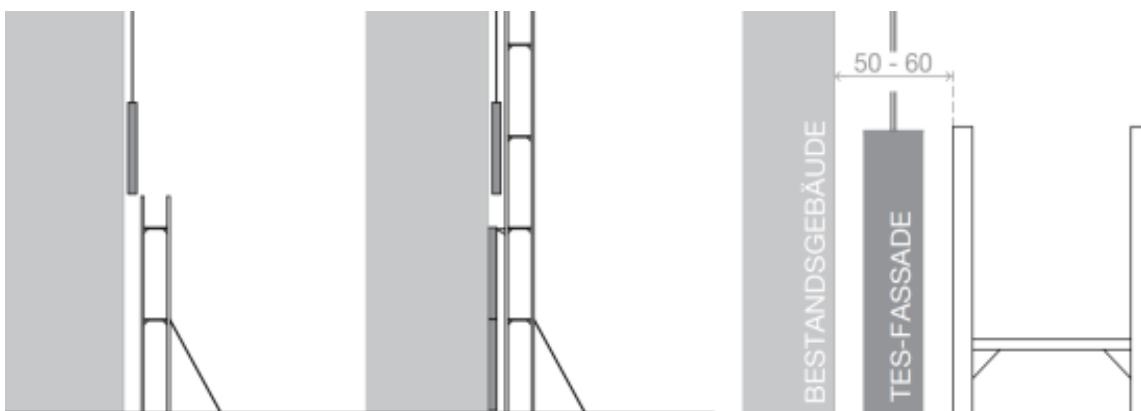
Montage der TES Elemente – das Gerüst wächst mit dem Baufortschritt mit
